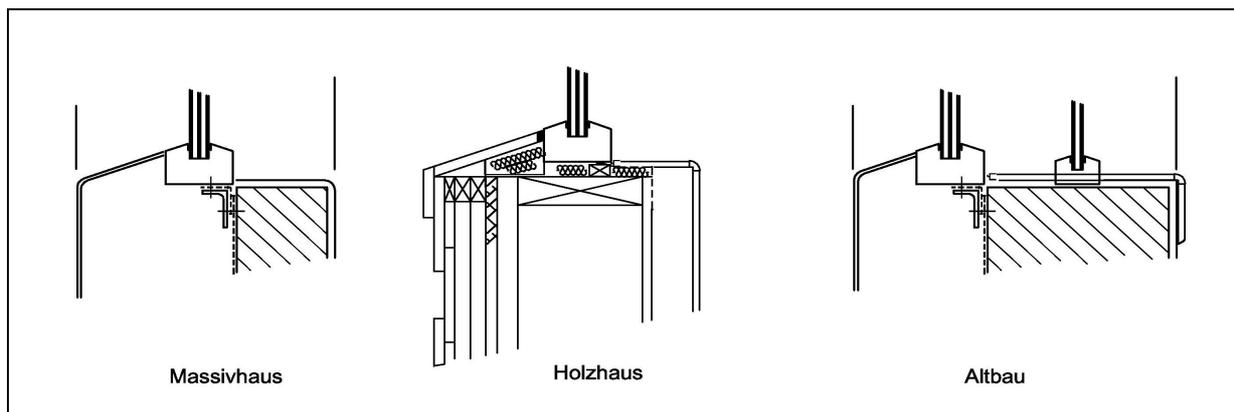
Prinzipdetail Leibung Massivhaus, Holzhaus, Altbau
